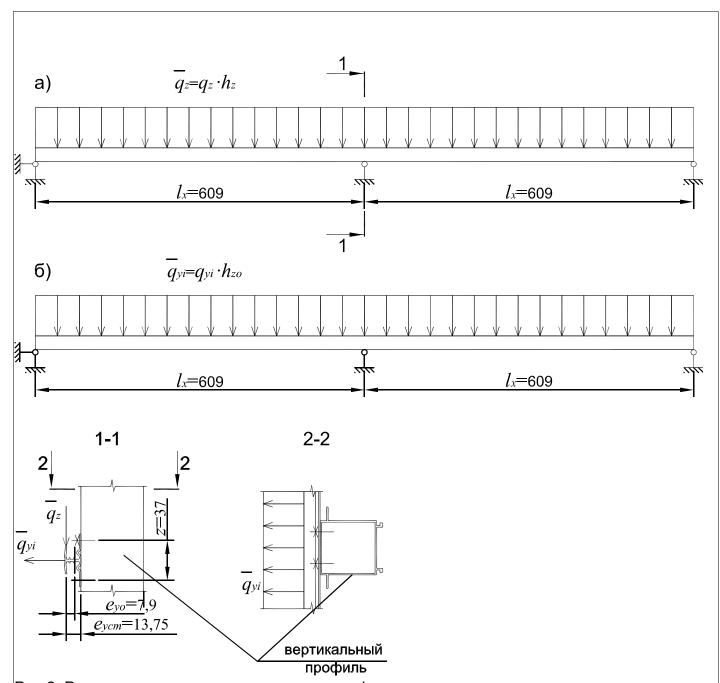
Расчетные схемы горизонтального профиля для угловых участков а - на вертикальные нагрузки; б - на ветровые нагрузки.
